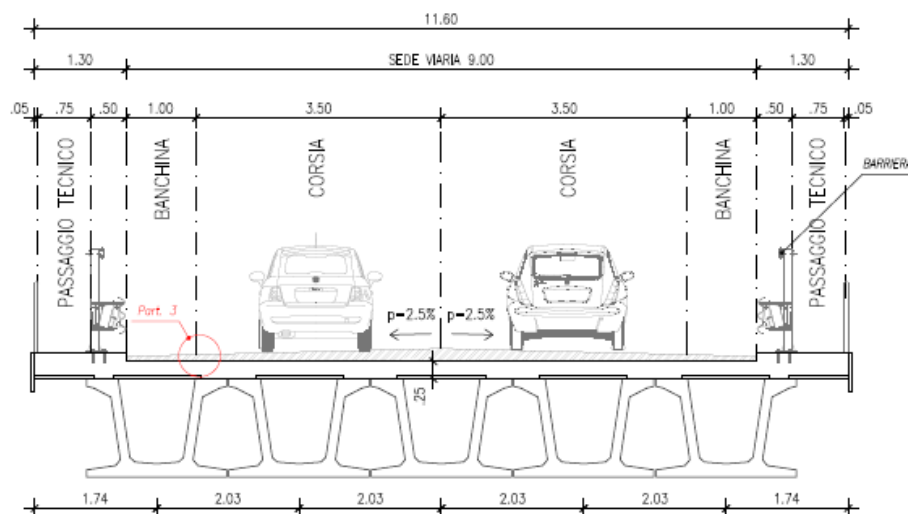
Sezione tipo Ponte sul Fosso Reale
